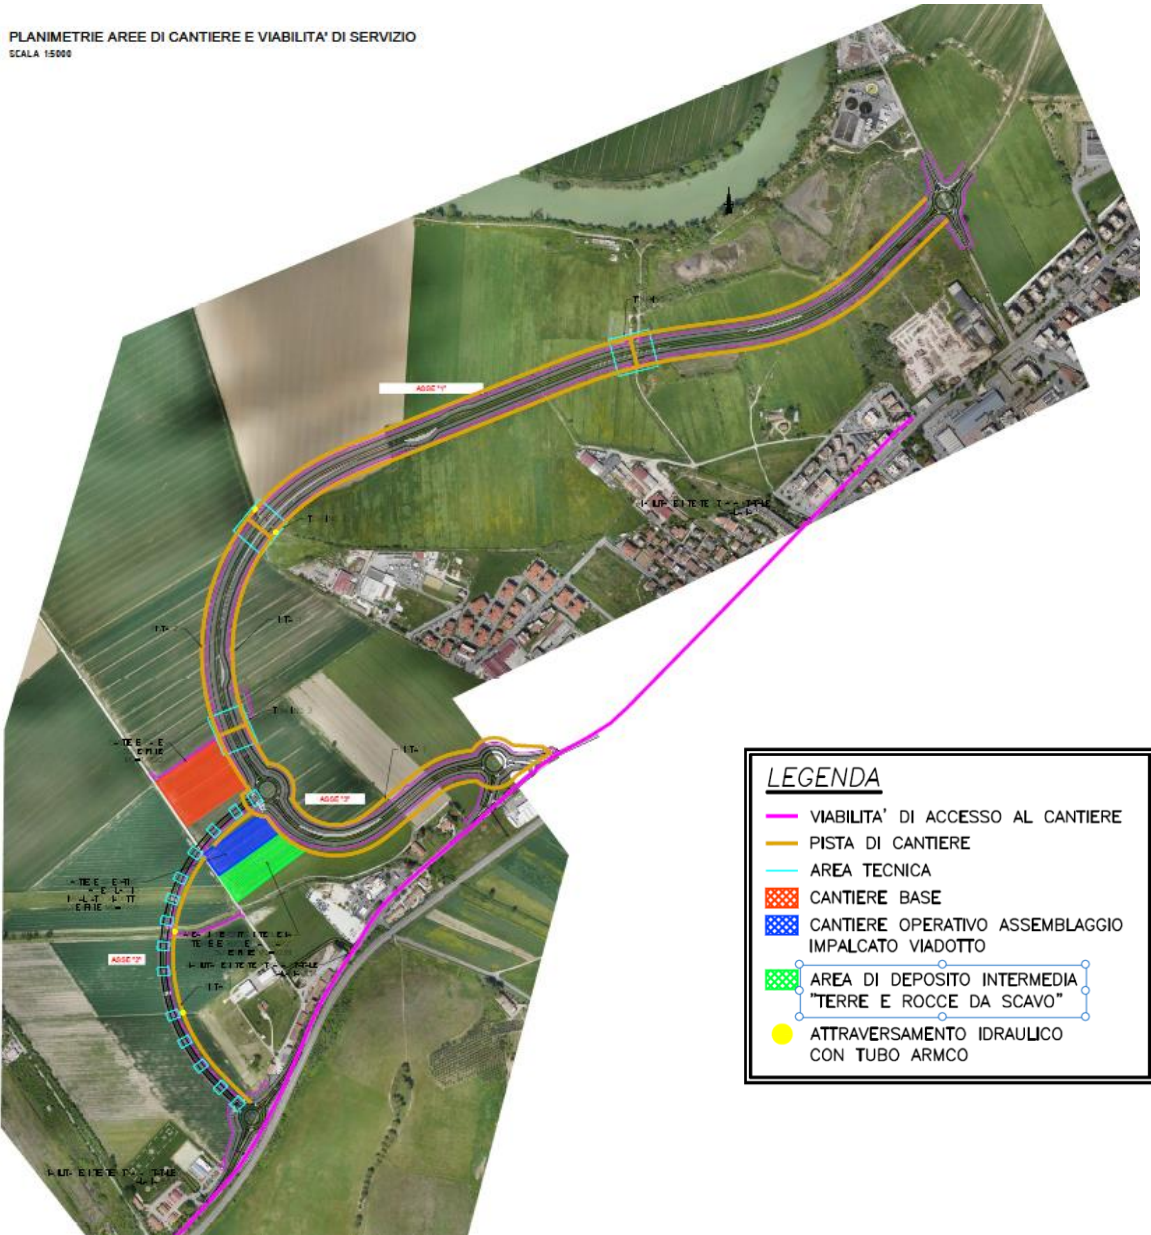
Planimetria aree di cantiere su Ortofoto – Soluzione 2
